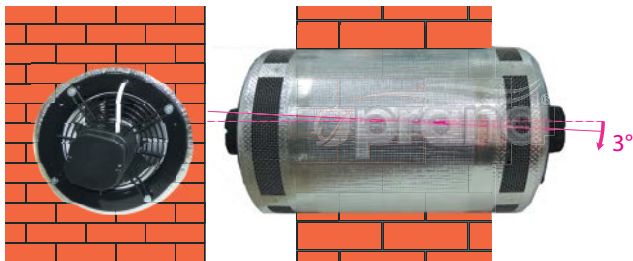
а) Схема установки рекуператора в стене (фронтальный разрез);
